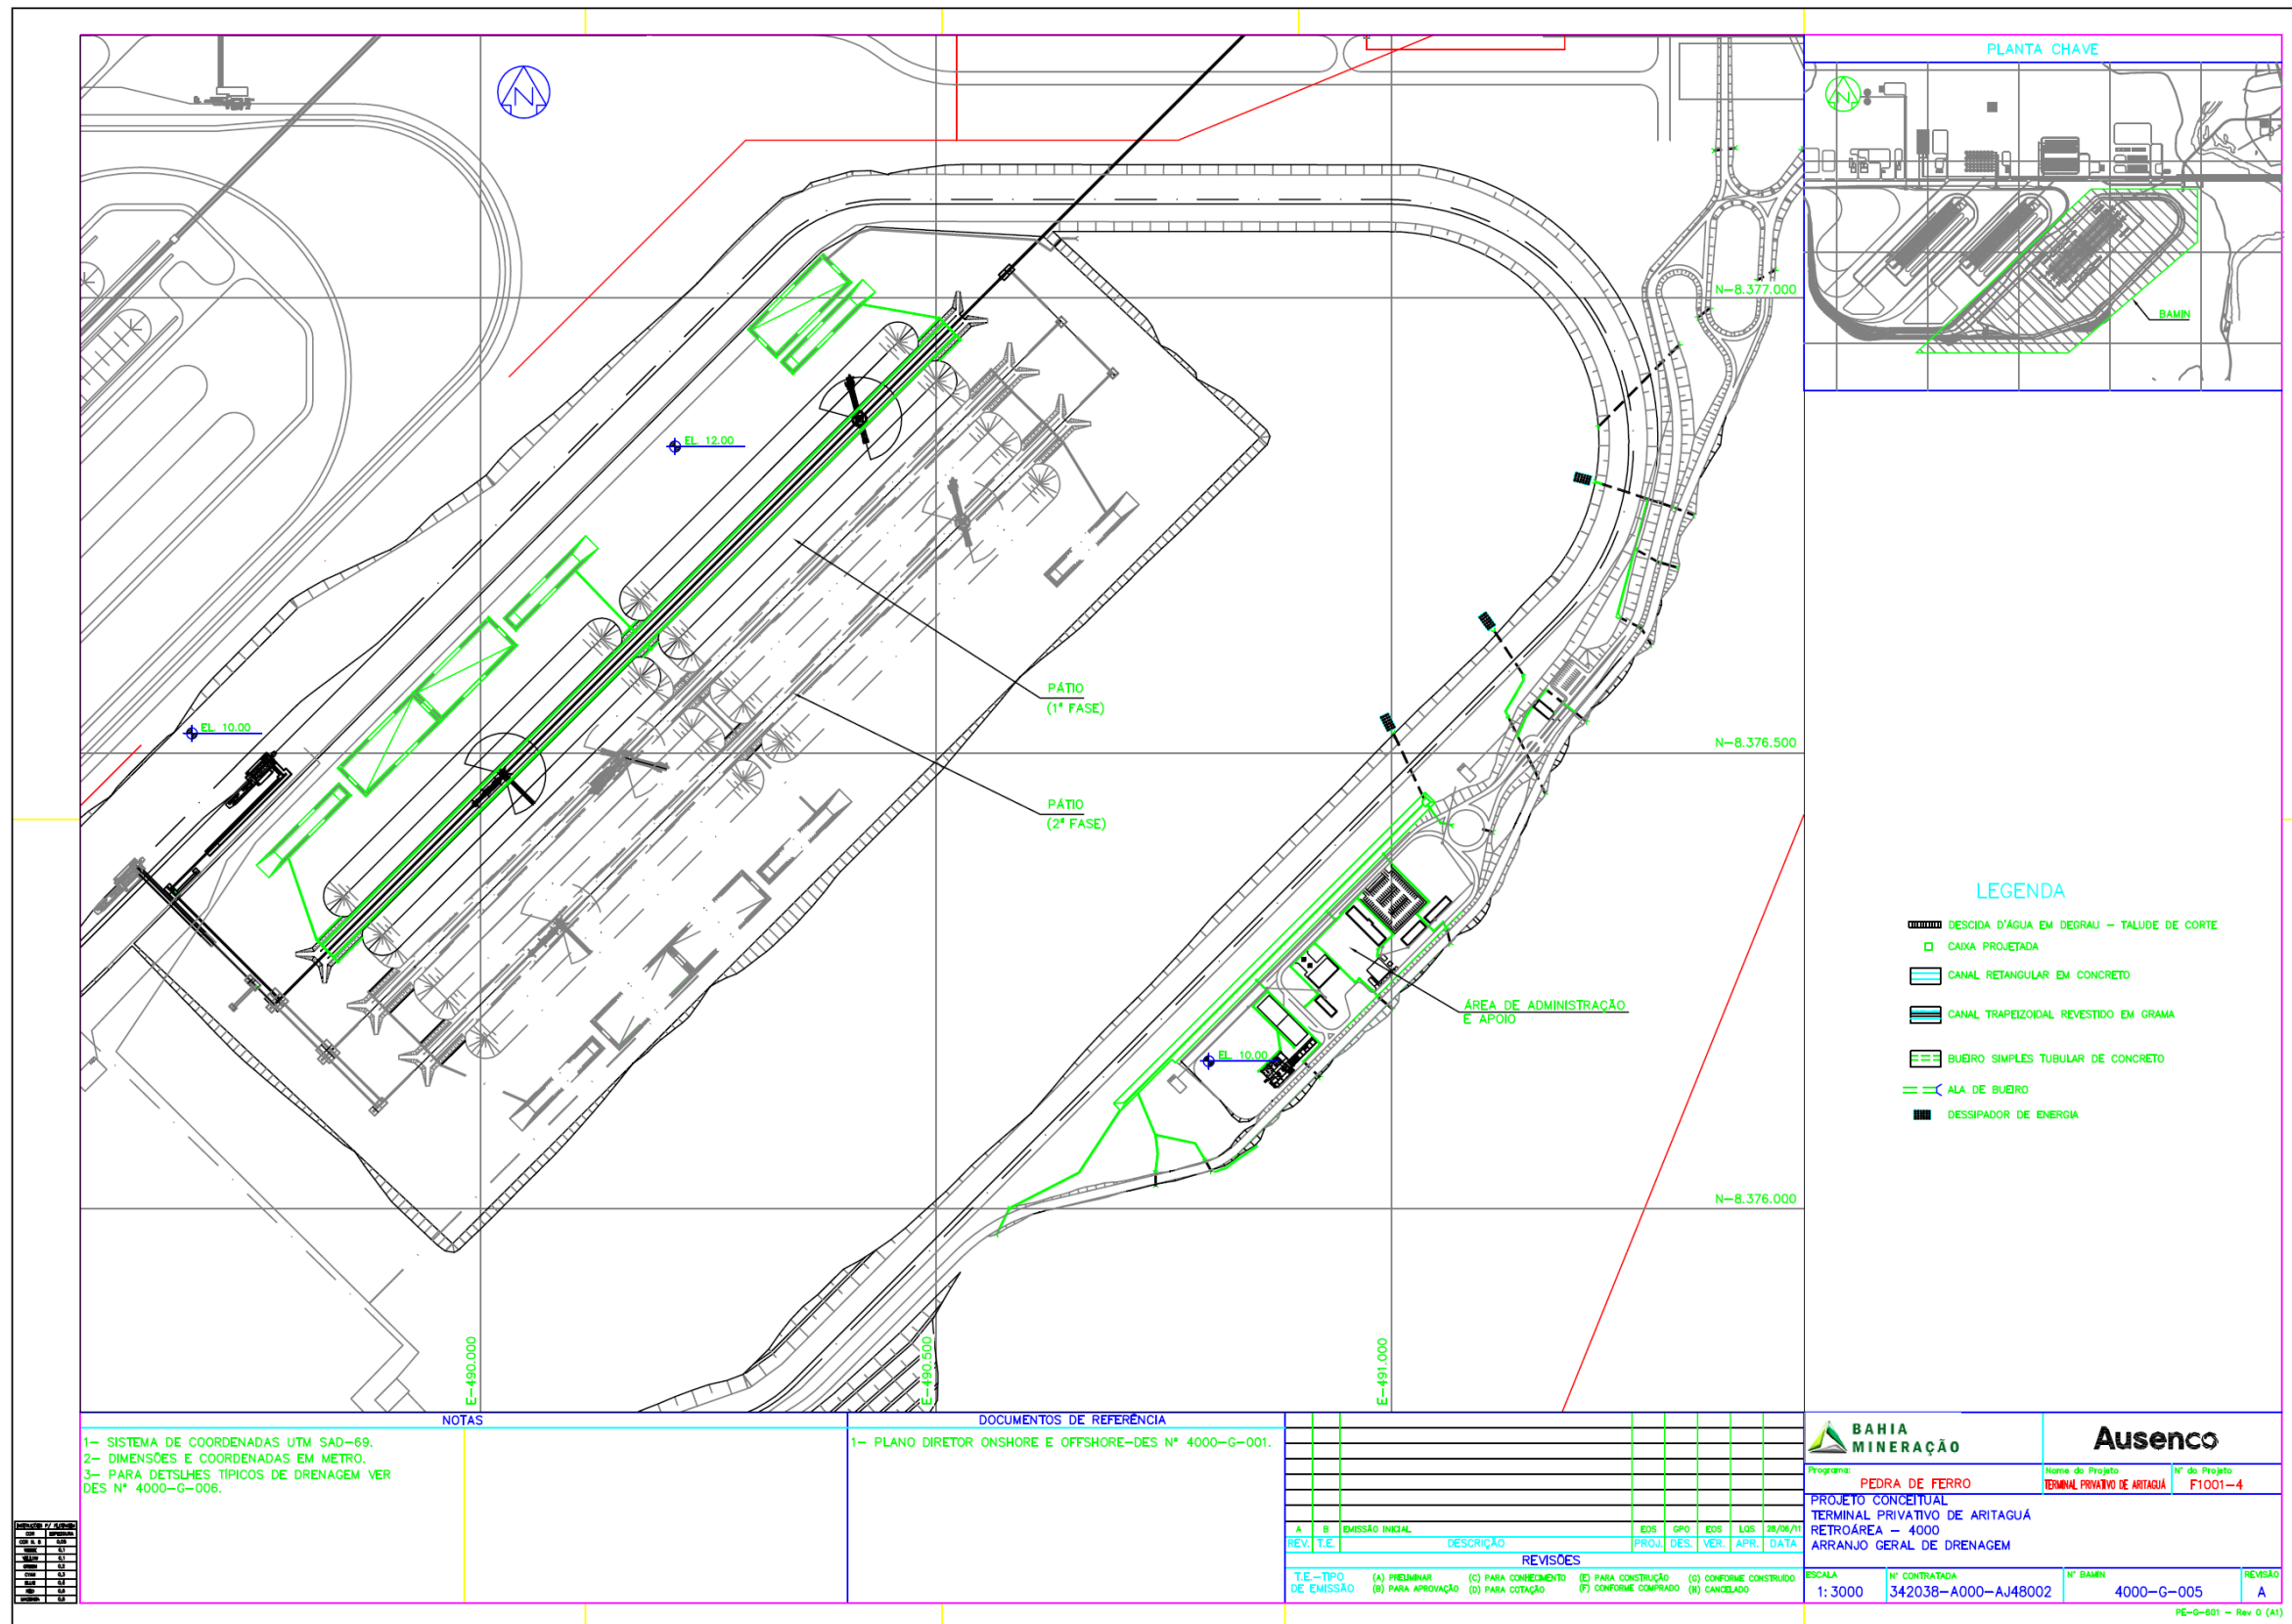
Arranjo Geral do Sistema de Drenagem Pluvial na Área do TUP BAMIN – Porto Sul
